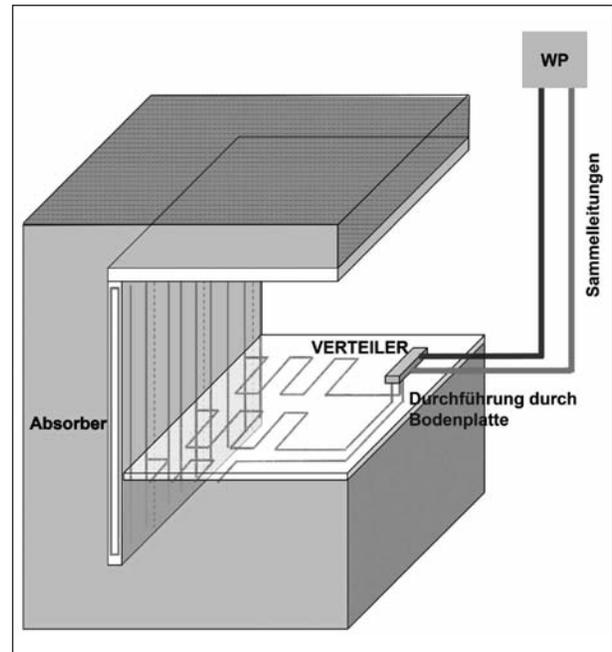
Beispielhafter Aufbau einer Tunnelthermie-Anlage bei einem in offener Bauweise errichteten Tunnelbauwerk (Deckelbauweise) mit Energieschlitzwänden und Energiebodenplatte. Die Anbindung der Energieschlitzwände erfolgt dabei im Bereich der Bodenplatte. Sämtliche Absorberleitungen werden durch die Bodenplatte in das Tunnelinnere geführt, wo auch der Verteiler situiert ist (z. B. in einer Nische). Vom Verteiler verlaufen die Sammelleitungen bis zum Abnehmer
